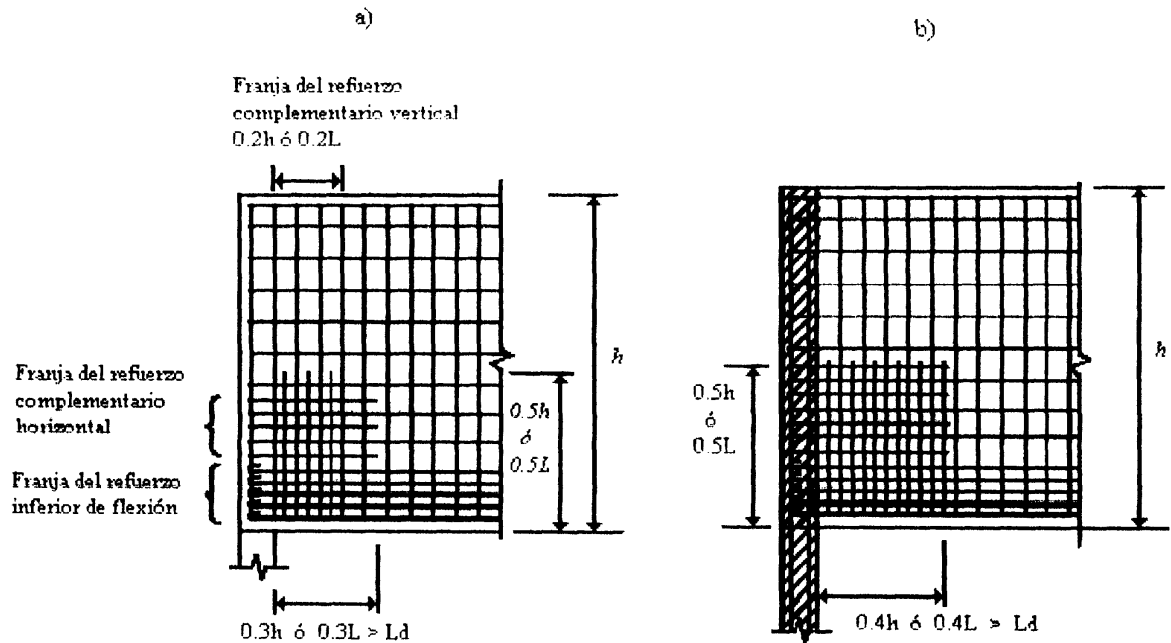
a) Refuerzo complementario en una zona de apoyo directo de una viga diafragma no atiesada. b) Refuerzo en una zona de apoyo indirecto.
